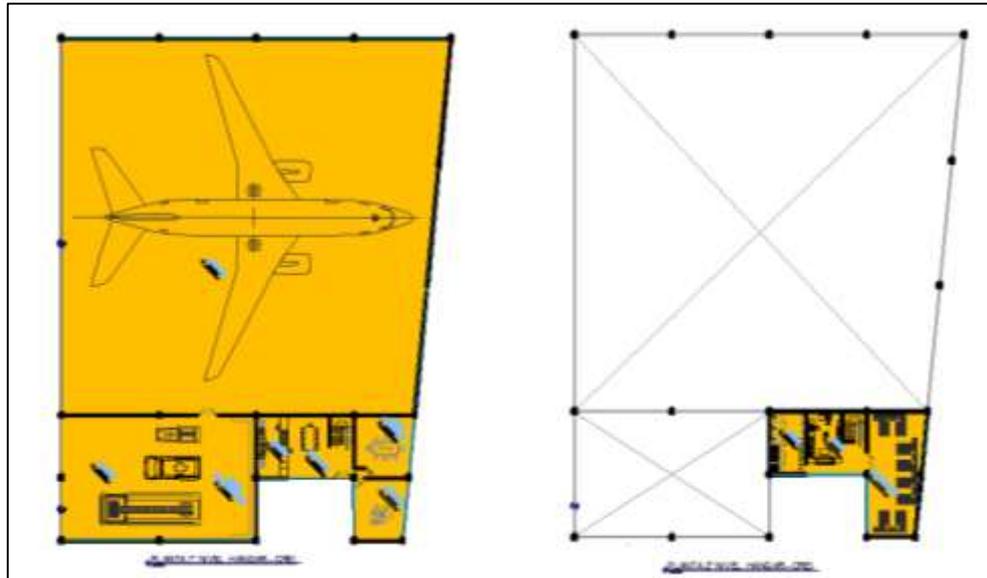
C.R.E.I.; fuente: plano de zonificación de Módulos A-02
